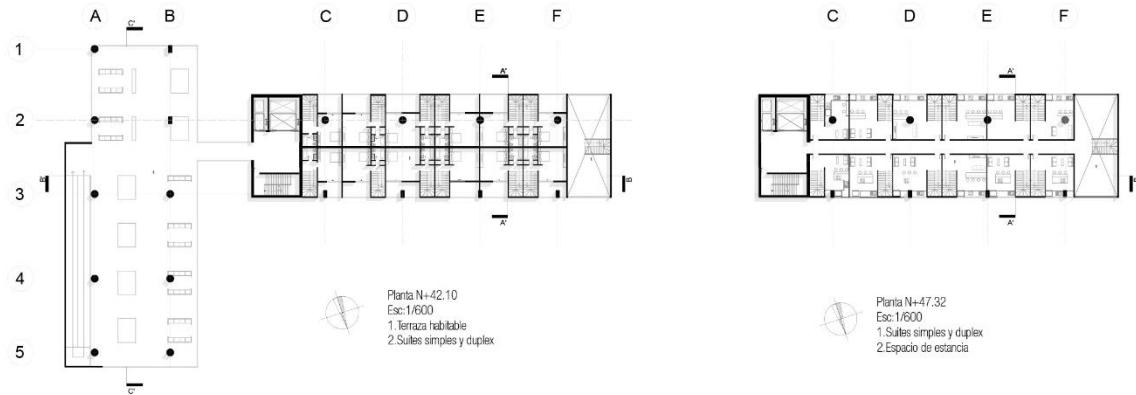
Planta N+42.10/+47.32. *Elaboración Propia.
